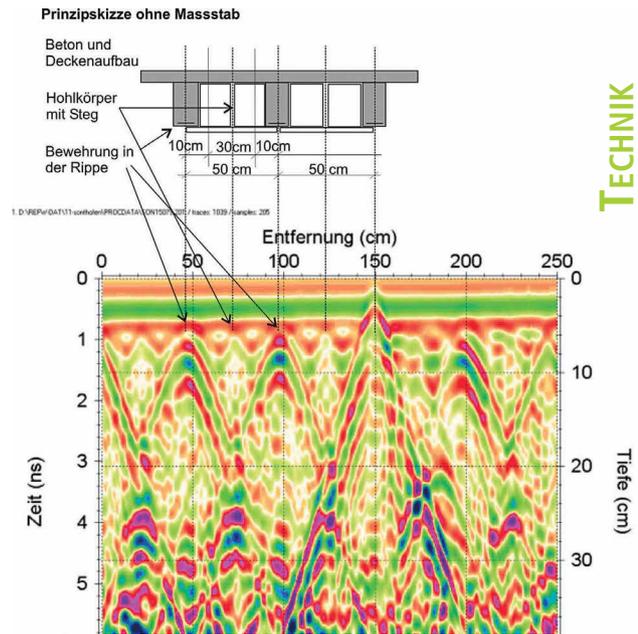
Radargramm, an einer Hohlkörperdecke aufgezeichnet; an der Bewehrung in den Stegen treten typische Diffraktionen auf.
